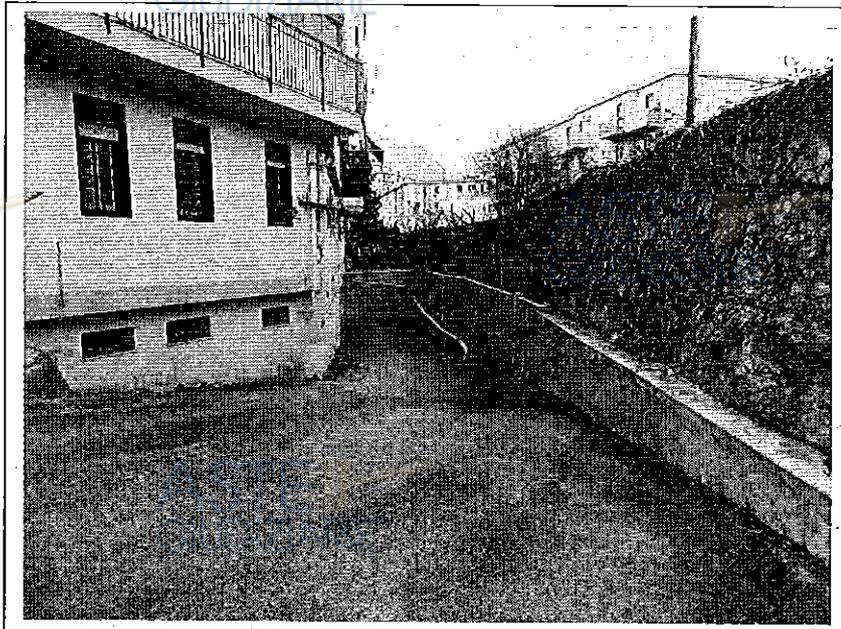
Rampa di accesso al piano interrato dell'edificio denominato "lotto A".
